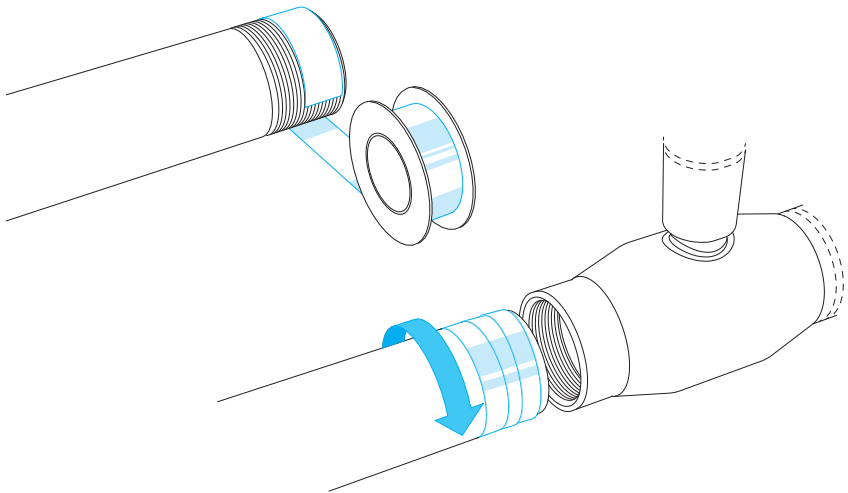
Abdichten und Anschließern einer Gewindeverbindung
